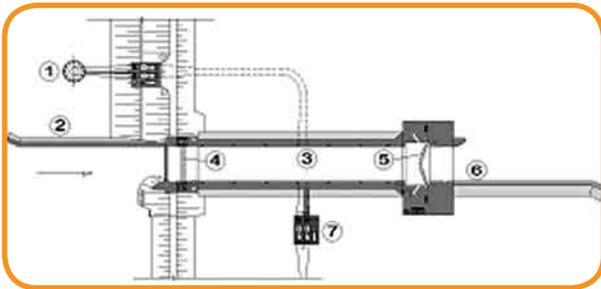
Planta Esquemática da Eclusa II, onde: 1 – Tomada d'Água; 2 – Muro Guia de Montante; 3 – Câmara; 4 – Comporta de Montante; 5 – Comporta de Jusante; 6 – Muro Guia de Jusante; e, 7 – Bloco de Esvaziamento.
